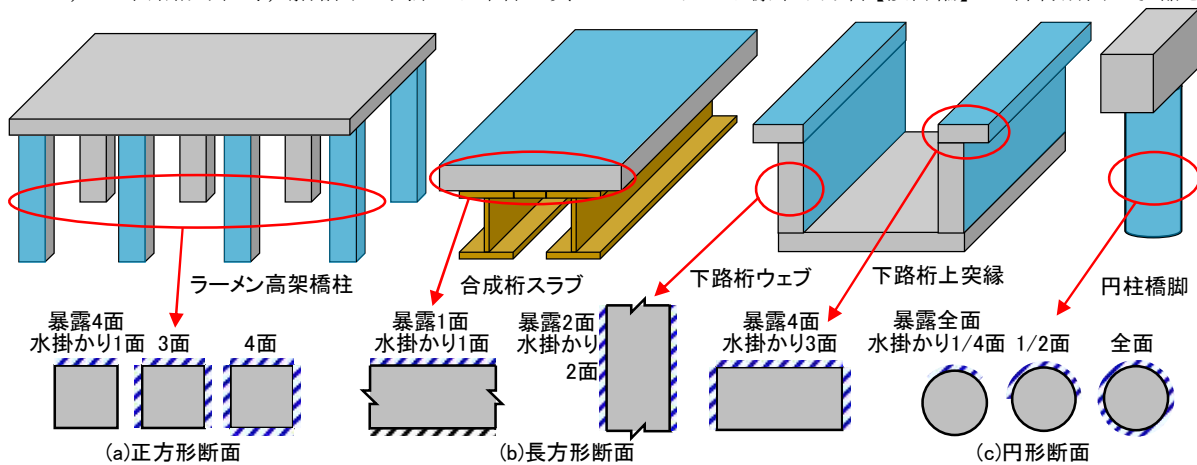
解析モデルの形状および水掛かり条件と対応するコンクリート構造物の部位の例
